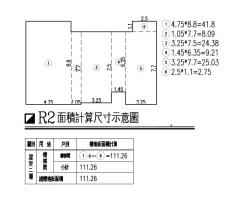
屋突一層平面圖 (比例尺 1/200)
